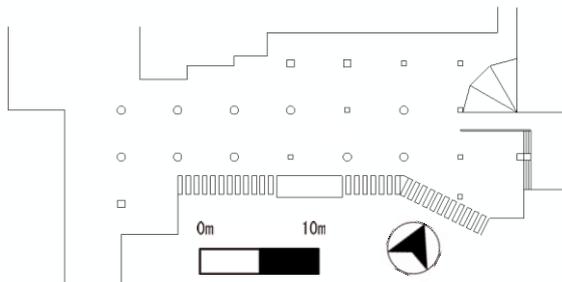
大阪市営地下鉄御堂筋線梅田駅北口の平面図
